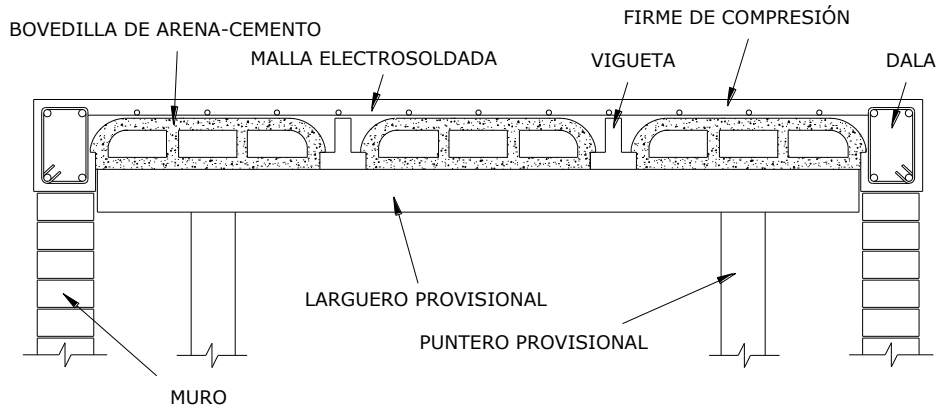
Corte transversal de un sistema de piso a base de Vigueta y bovedilla de arena-cemento.
